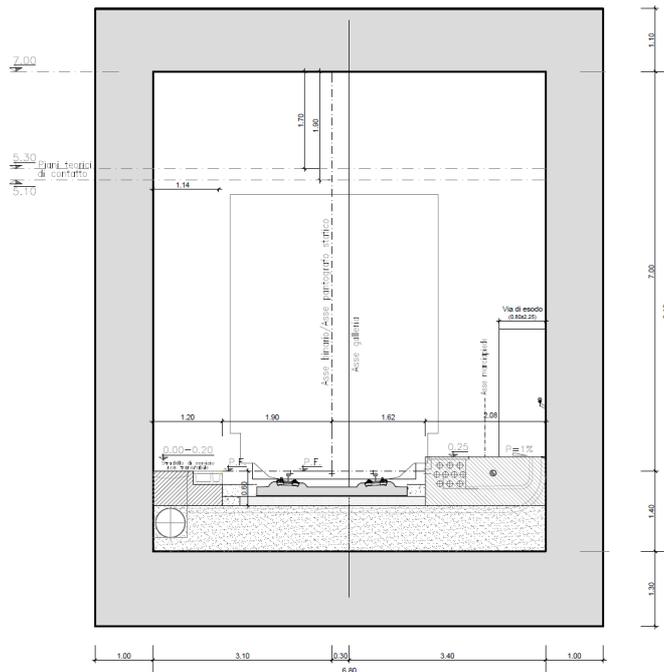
Sezione tipo GA singolo binario con armamento su piastra - rettilineo
